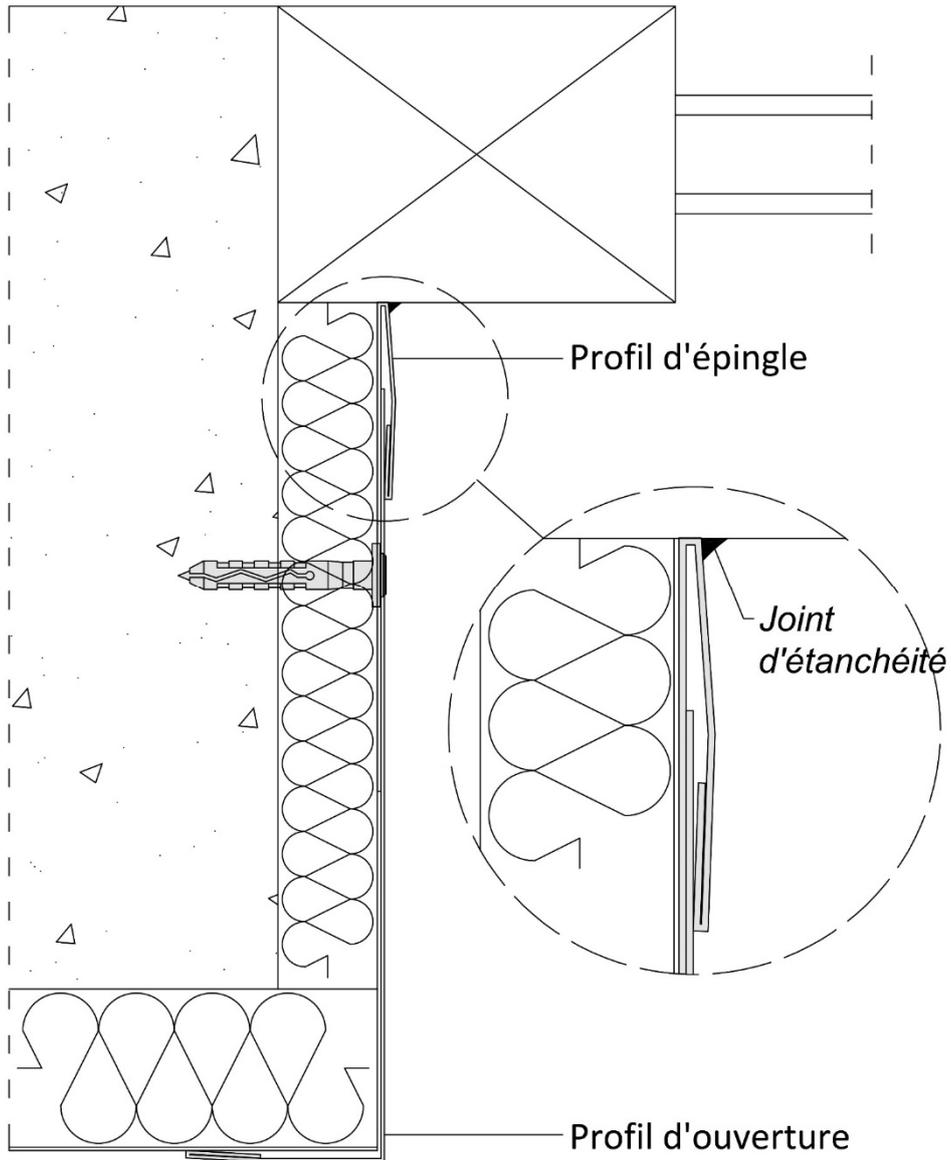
Habillage de fenêtre – Linteau et appui (coupe verticale)
